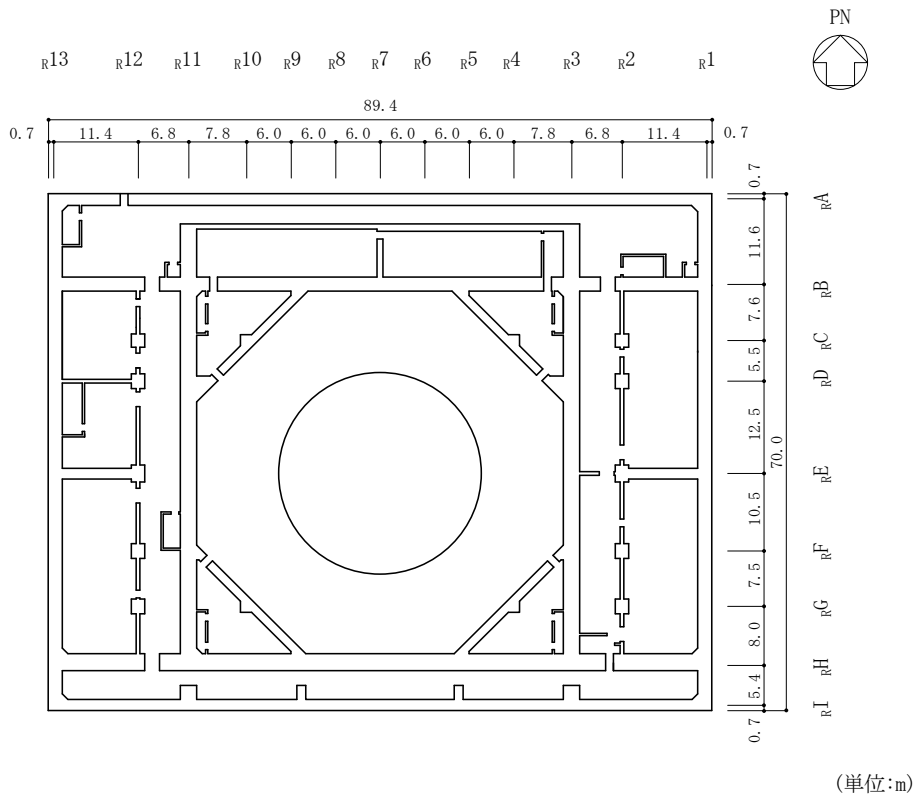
(1) 原子炉建物の概略平面図 (EL 1.3m*)
